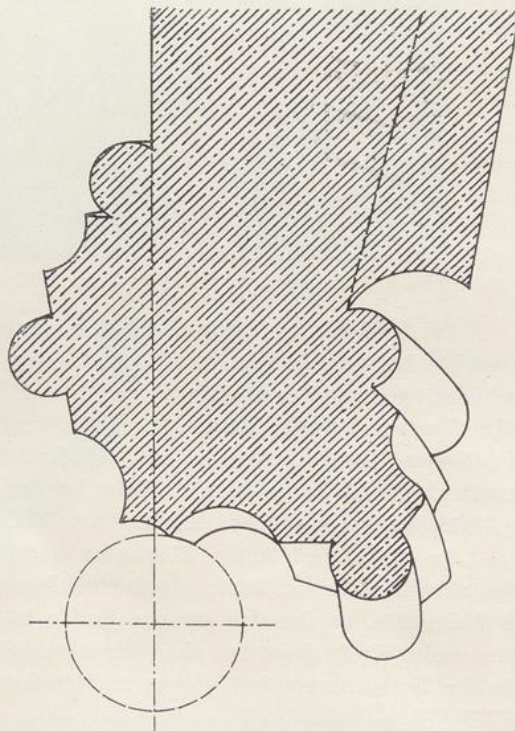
Wange der Nordwesttreppe im Schlosse zu Dresden. Grundriß.
